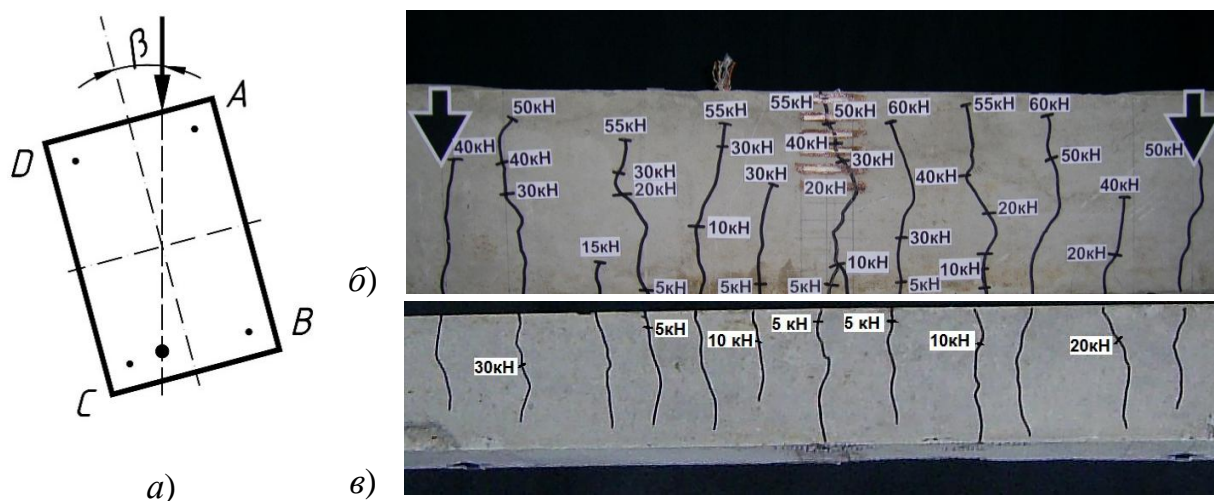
Розповсюдження тріщин на суміжних гранях косозігнутої залізобетонної балки: а – схема поперечного перерізу балки; б – грань DC; в – грань CB
